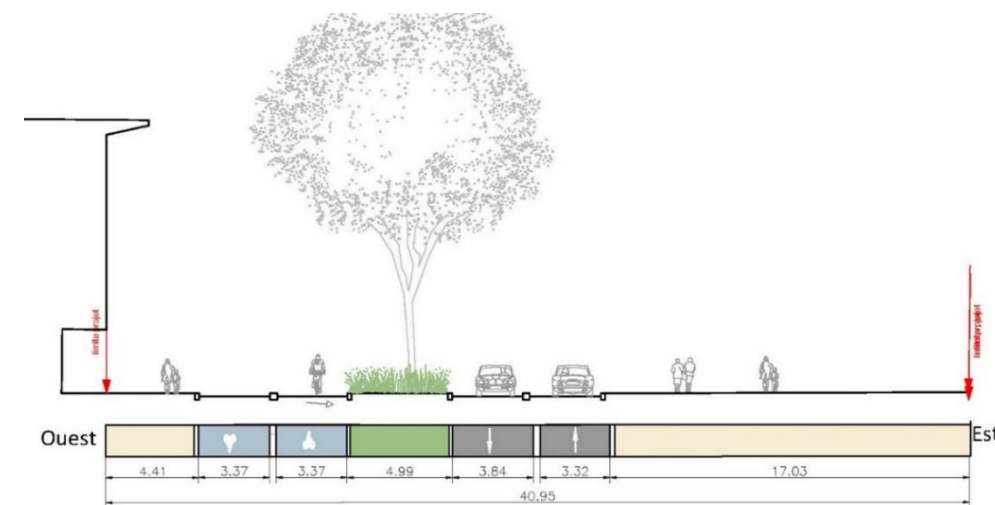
Profil en travers actuel de l'avenue Gaston Berger
